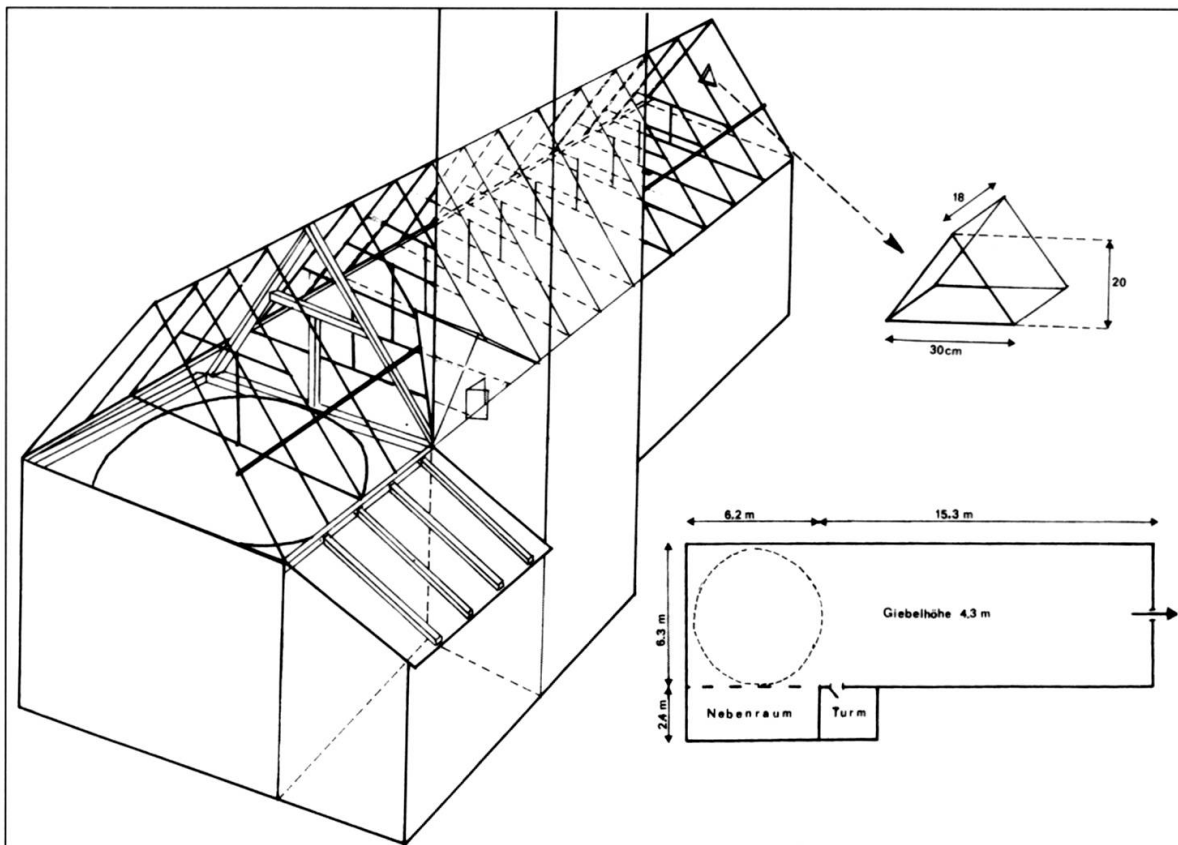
Perspektivische Darstellung und Grundriss der Kirche von Castrisch.
